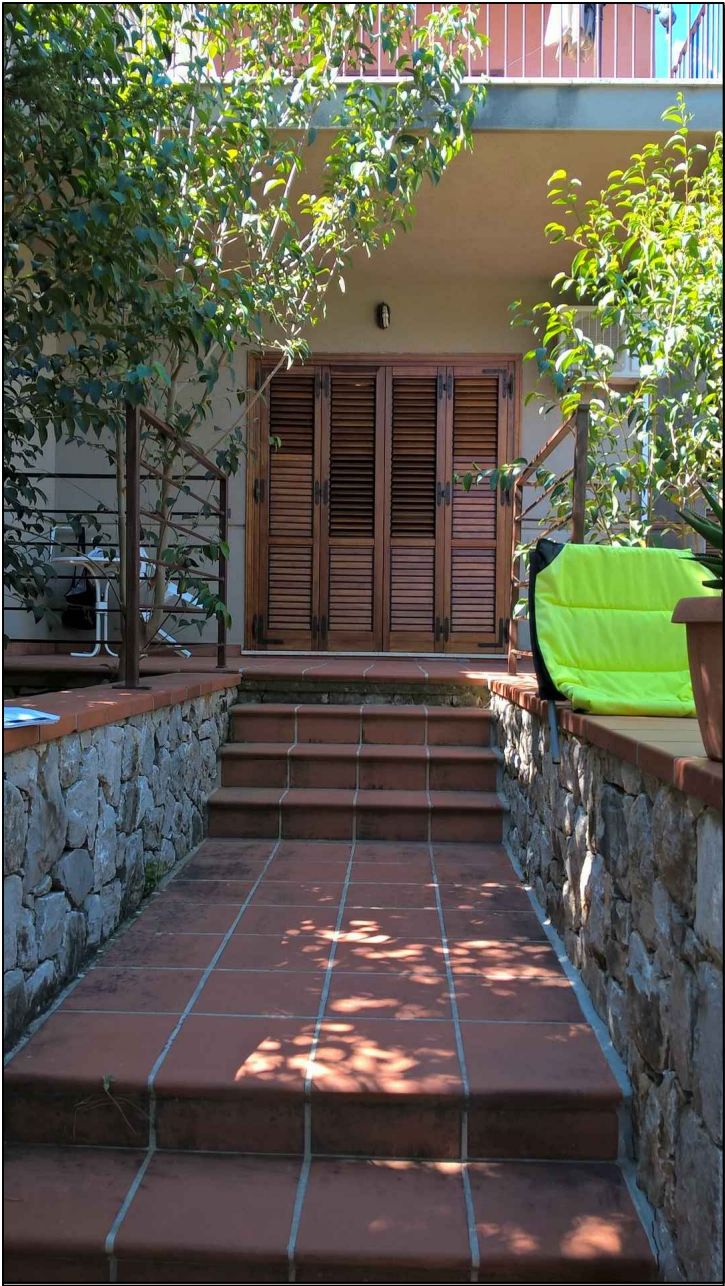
INGRESSO LATO VALLE E PROSPETTO
